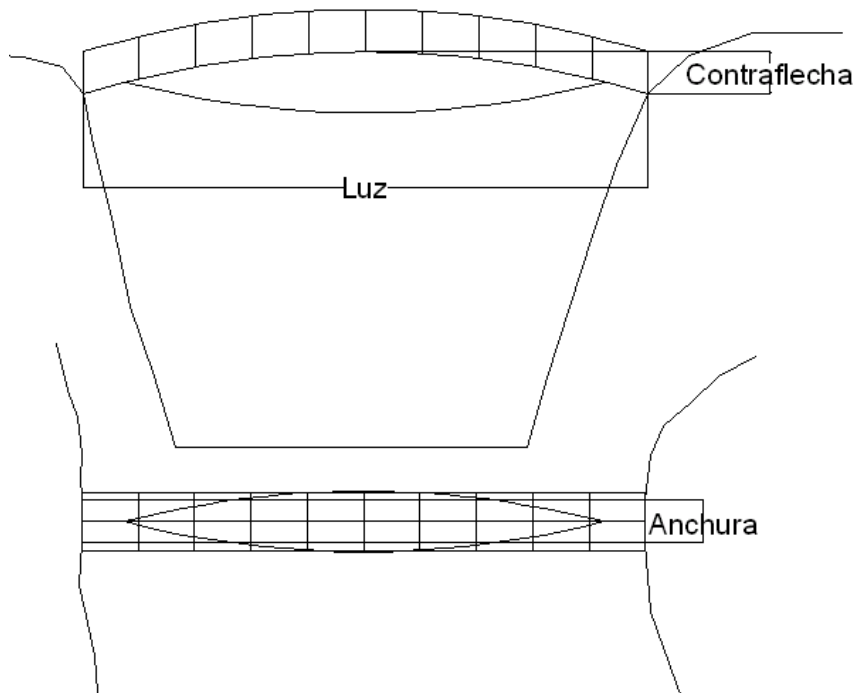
Geometría (alzado y planta) y emplazamiento genérico de la pasarela
